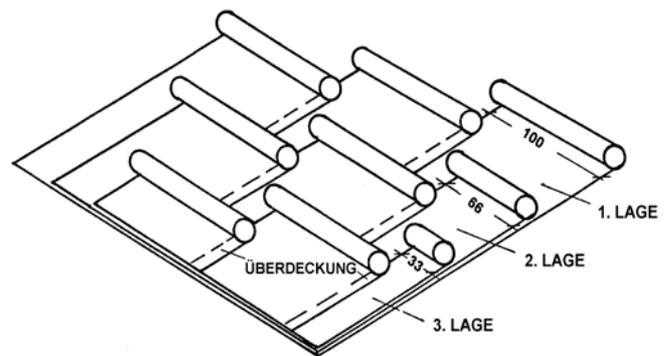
Dreilagige Bitumenbahnabdichtung [1]
